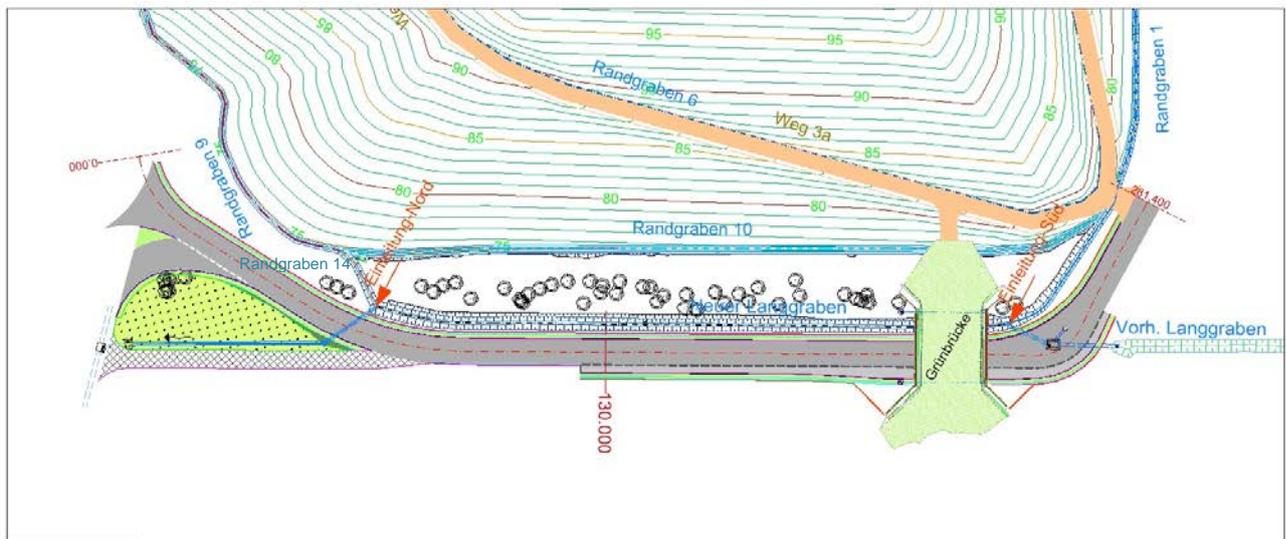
Lageplan Oberflächenentwässerung mit Darstellung des „Neuen“ Langgrabens
